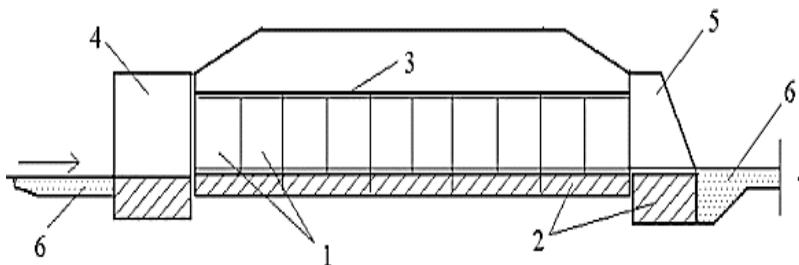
Дорожная труба: 1 – звенья трубы; 2 – фундаменты; 3 – гидроизоляция; 4 – входной оголовок; 5 – выходной оголовок; 6 – укрепления русла водотока
